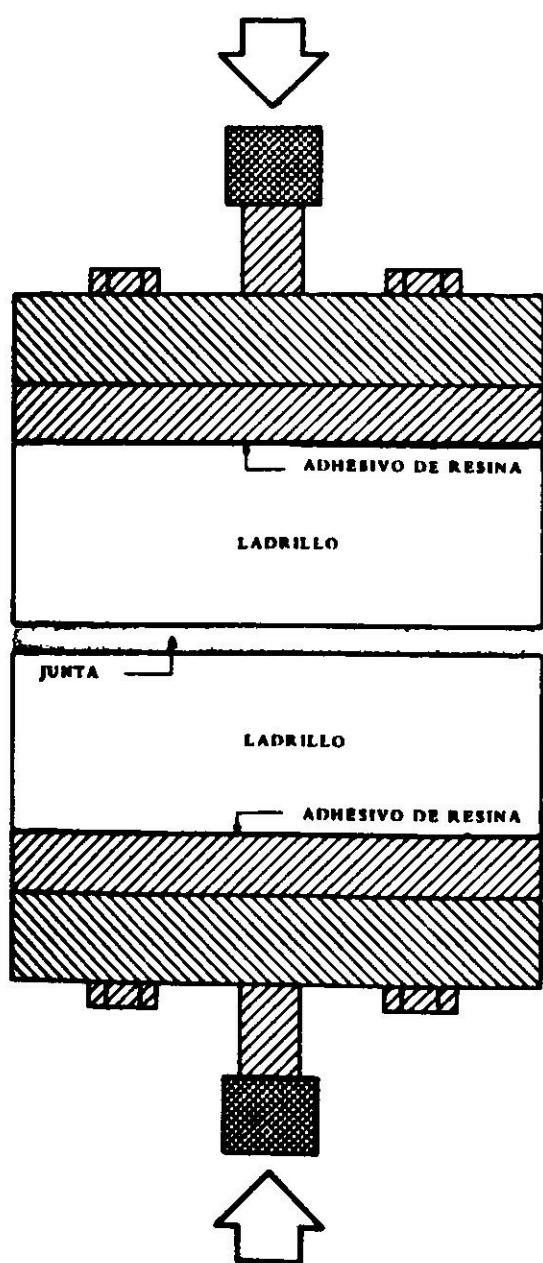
Probetas para adherencia por tracción, extraídas de muro de albañilería.
